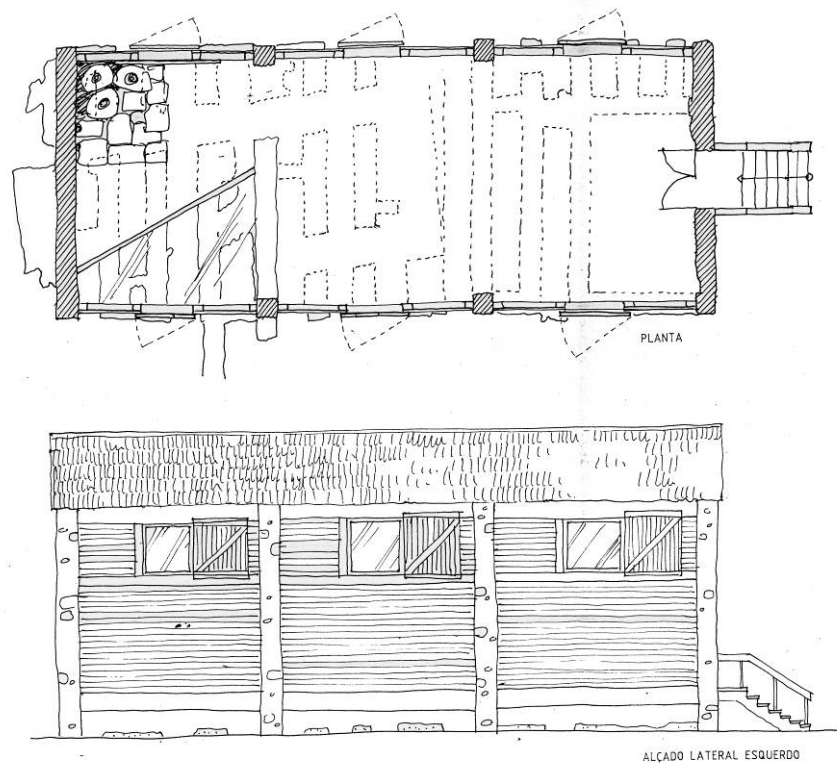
Proposta de reconstituição do celeiro. Planta e alçado lateral esquerdo do celeiro. Estudo efectuado pelo Arq. Rui Pimentel (Arquivisão).
